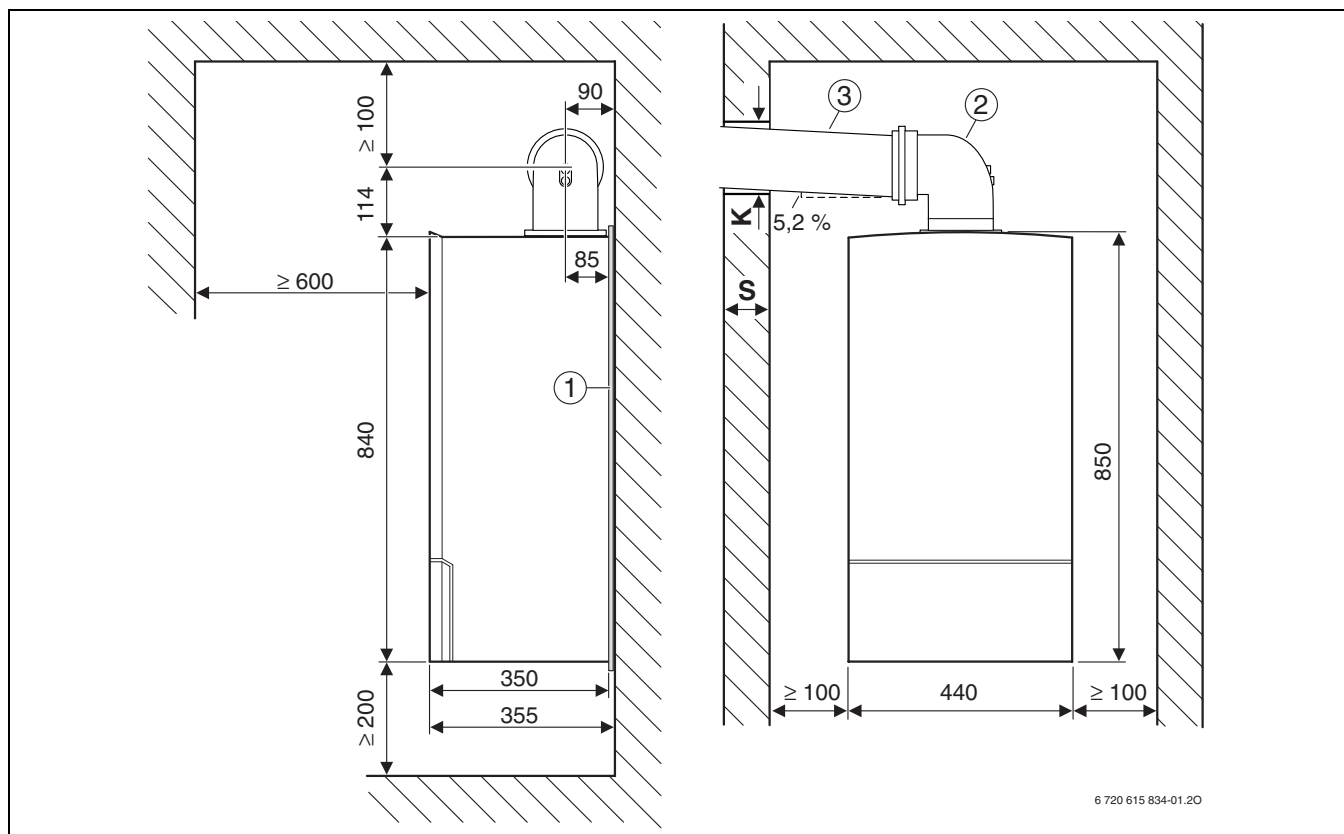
Conduit d'évacuation des fumées Ø 80/125 mm ou Ø 80 mm
